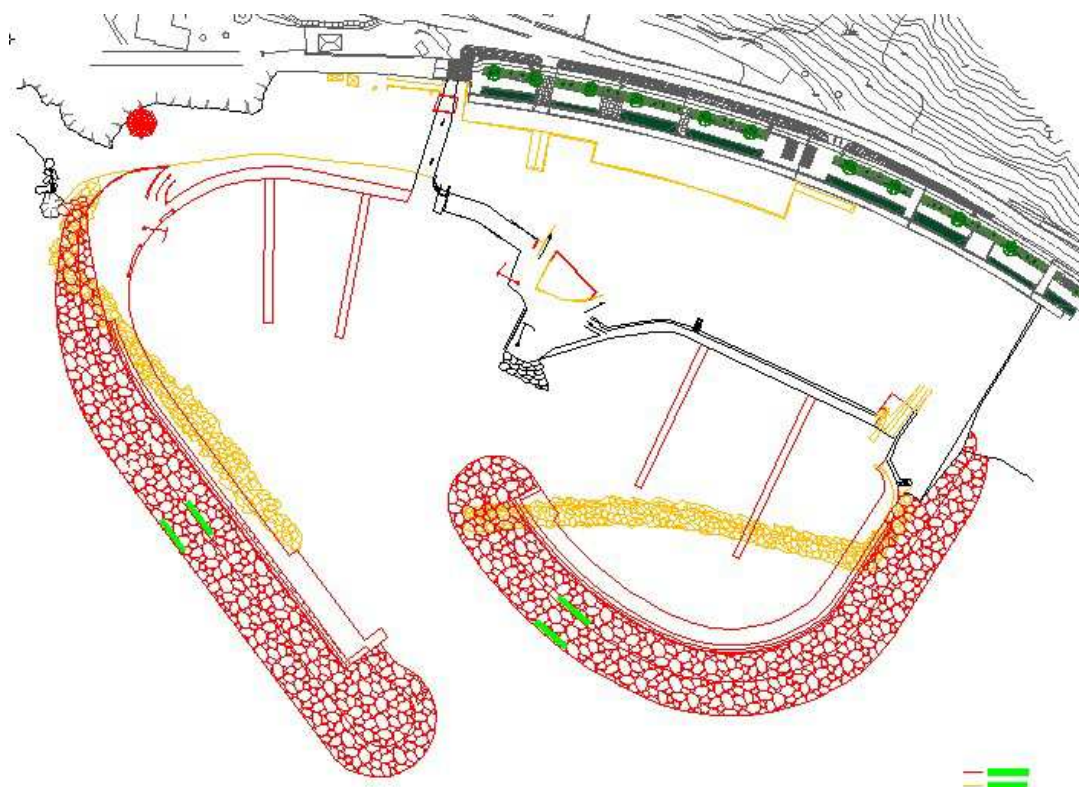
Planimetria di raffronto tra lo stato attuale e di progetto
